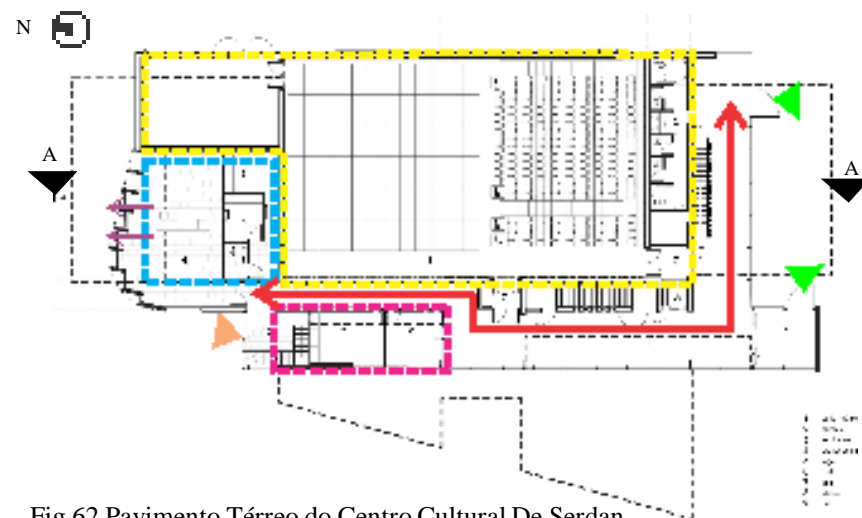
Pavimento Térreo do Centro Cultural De Serdan
